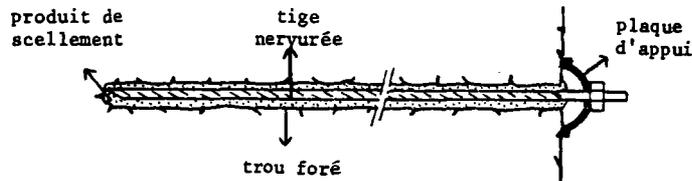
Boulon d'ancrage scellé sur toute sa longueur
